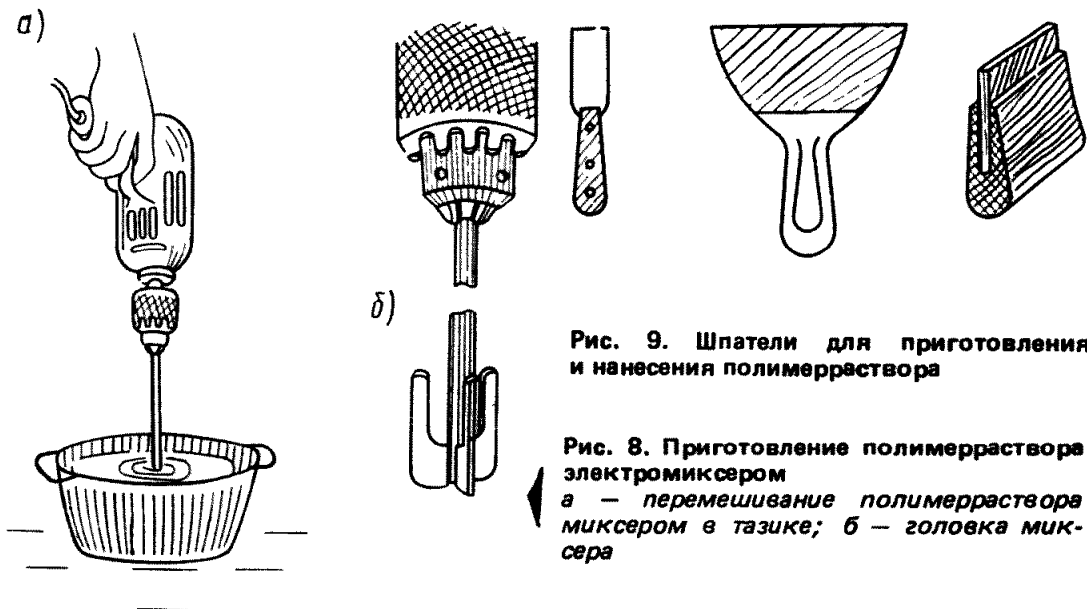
Шпатели для приготовления и нанесения полимерраствора
